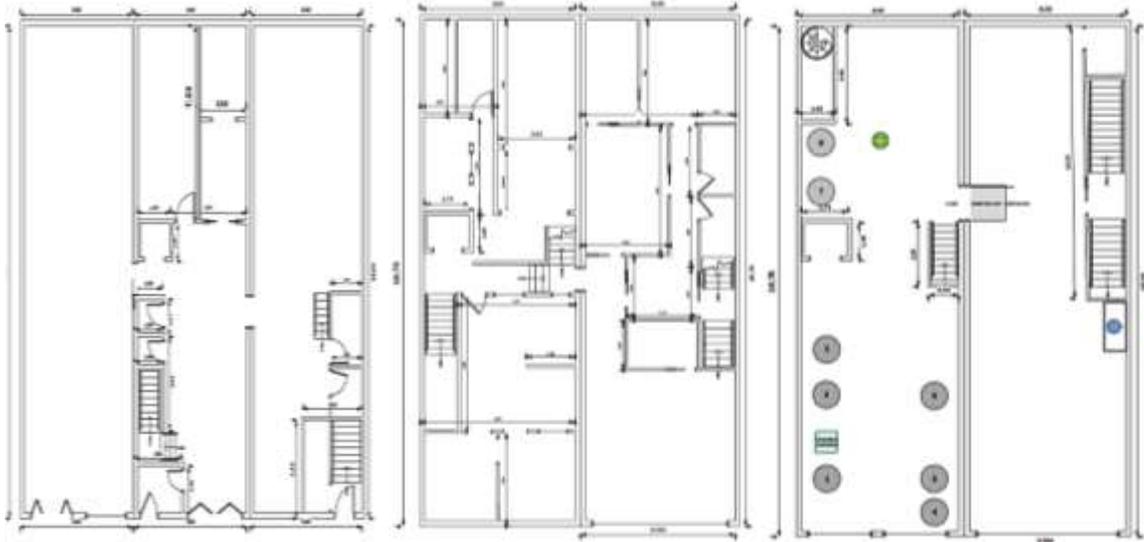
Vista Frontal Planta Industria Suramericana de Sabores S.A.S.
